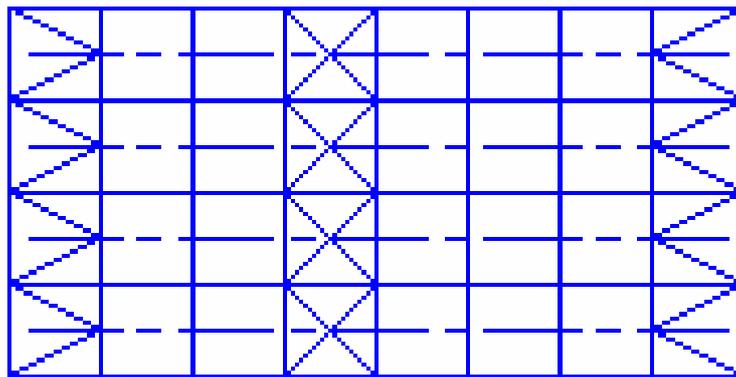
Contraventamentos de juntas às empenas (vento) e a meio da cobertura (variações térmicas)
